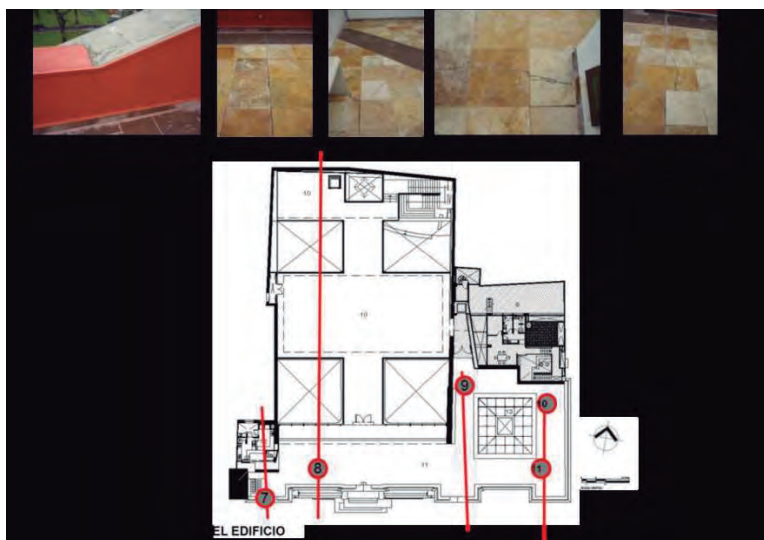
Localización de grietas planta alta del Museo Federico Silva.
